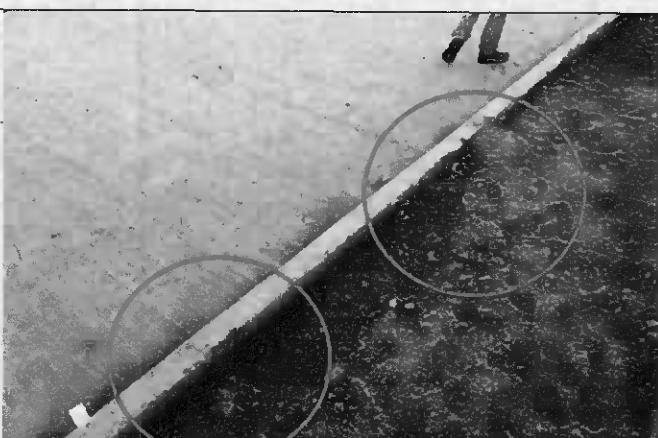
Defectos en las soleras de hormigón
